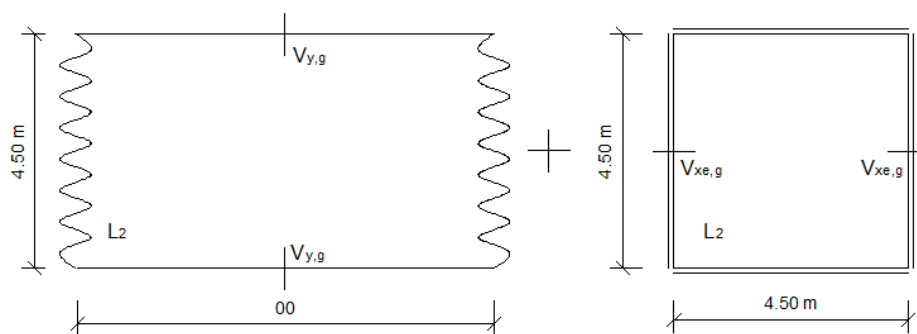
Configurações de lajes no cálculo da força cortante da laje L2.
